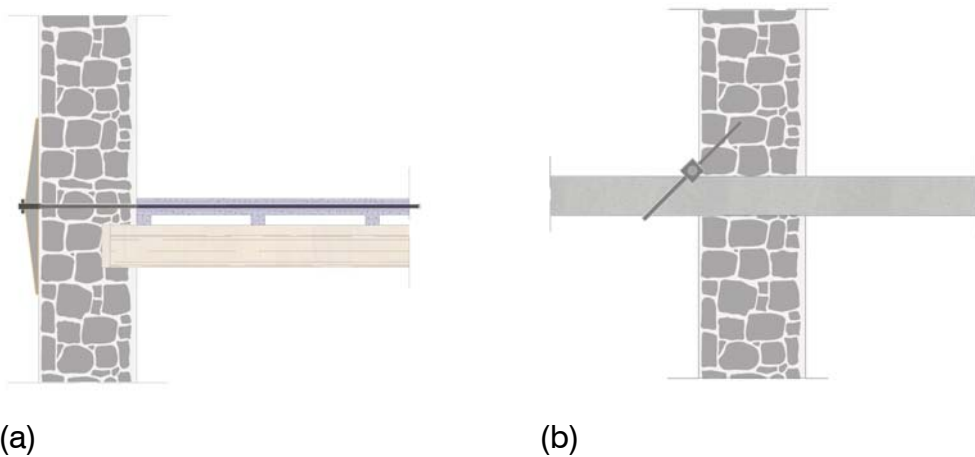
Vista in sezione di catena semplice aderente al muro trasversale a livello del solaio (a); schema di disposizione di capochiave a paletto (b).
